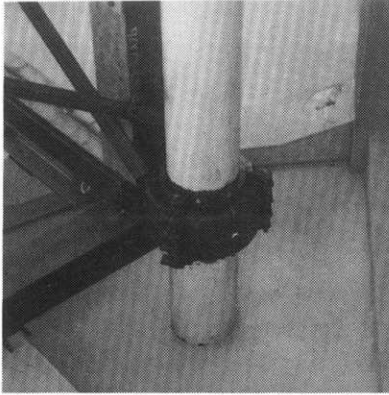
φ400フランジ部より漏水、フクロジョイントにて補修
